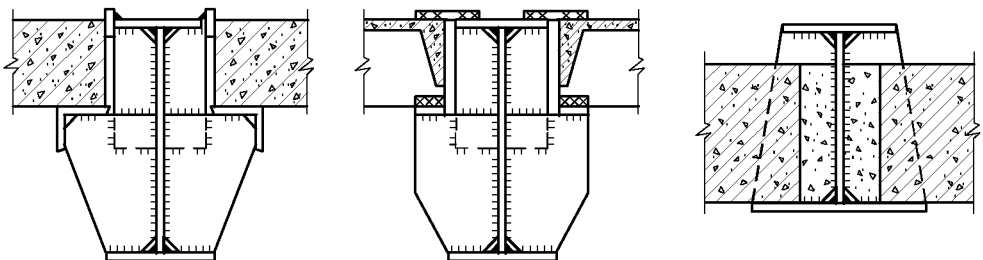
Узлы опирания железобетонных плит перекрытия на ригели
